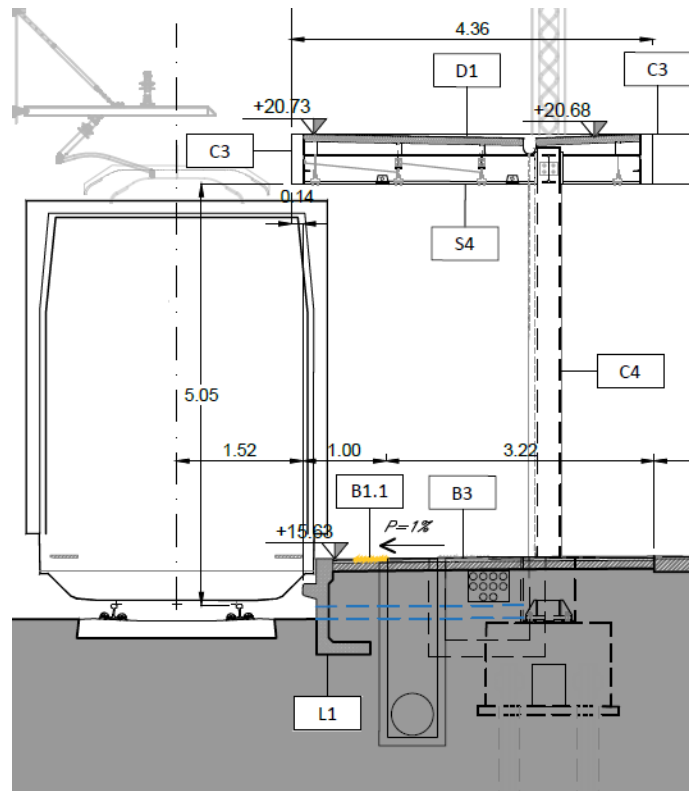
Sezione pensilina primo marciapiede a singolo appoggio
